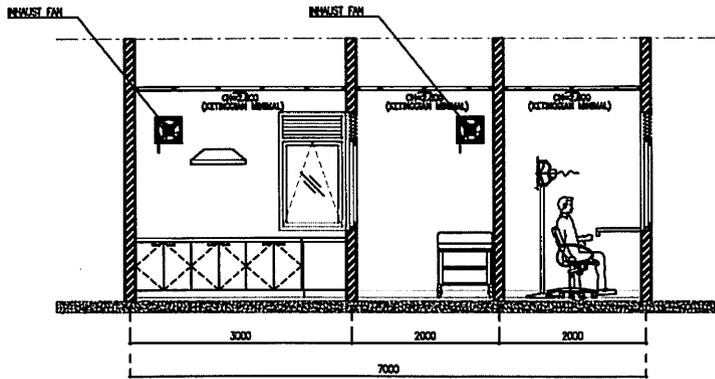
3D Ruang Pelayanan Laboratorium
